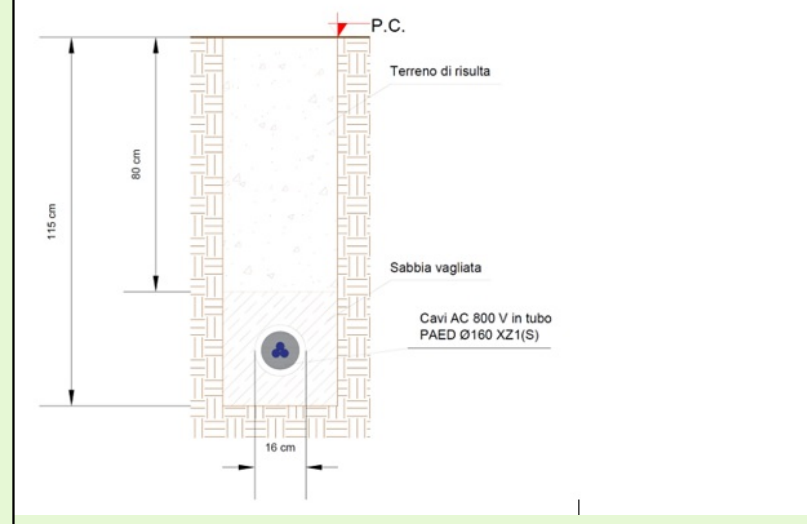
Sezione tipica di scavo per posa cavidotto BT di collegamento Skid di trasformazione – cabina di raccolta 36 kV
